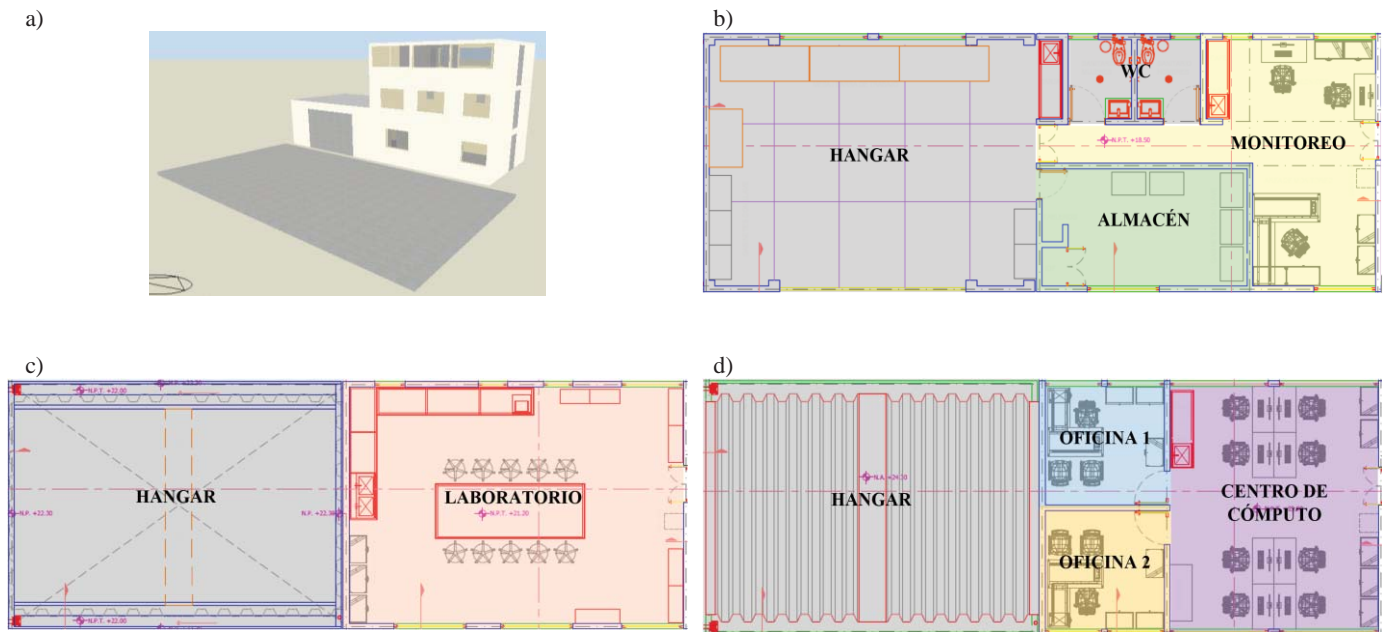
a) Visualización de caseta en 3D, Cortes en planta con las zonas térmicas del edificio: b) Primera planta, c) Segunda planta y d) Tercera planta.
